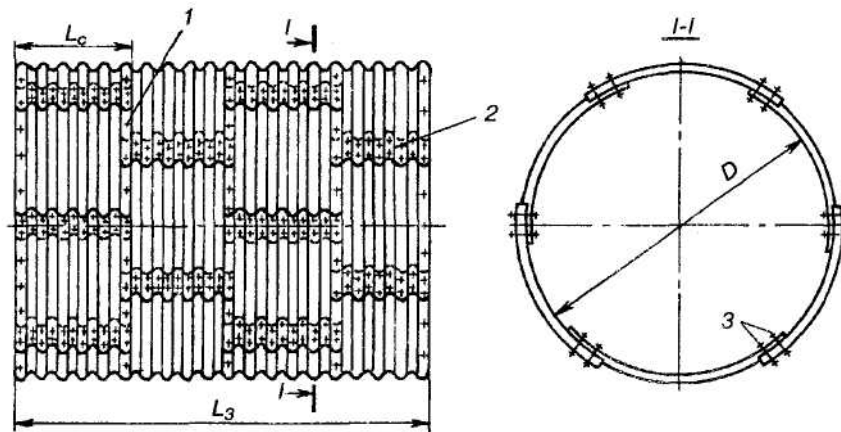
Конструкция трубы из гофрированной стали:
